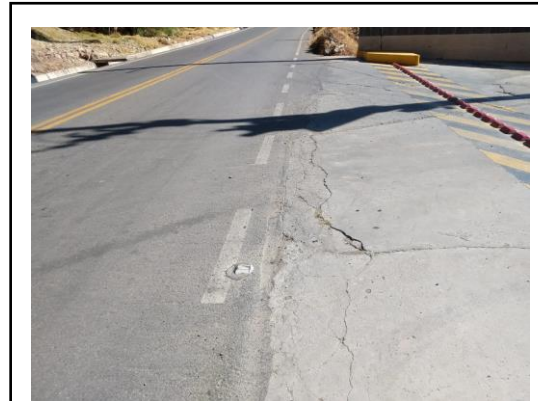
Fallas tipo "B" Fisura longitudinal de junta de construcción
